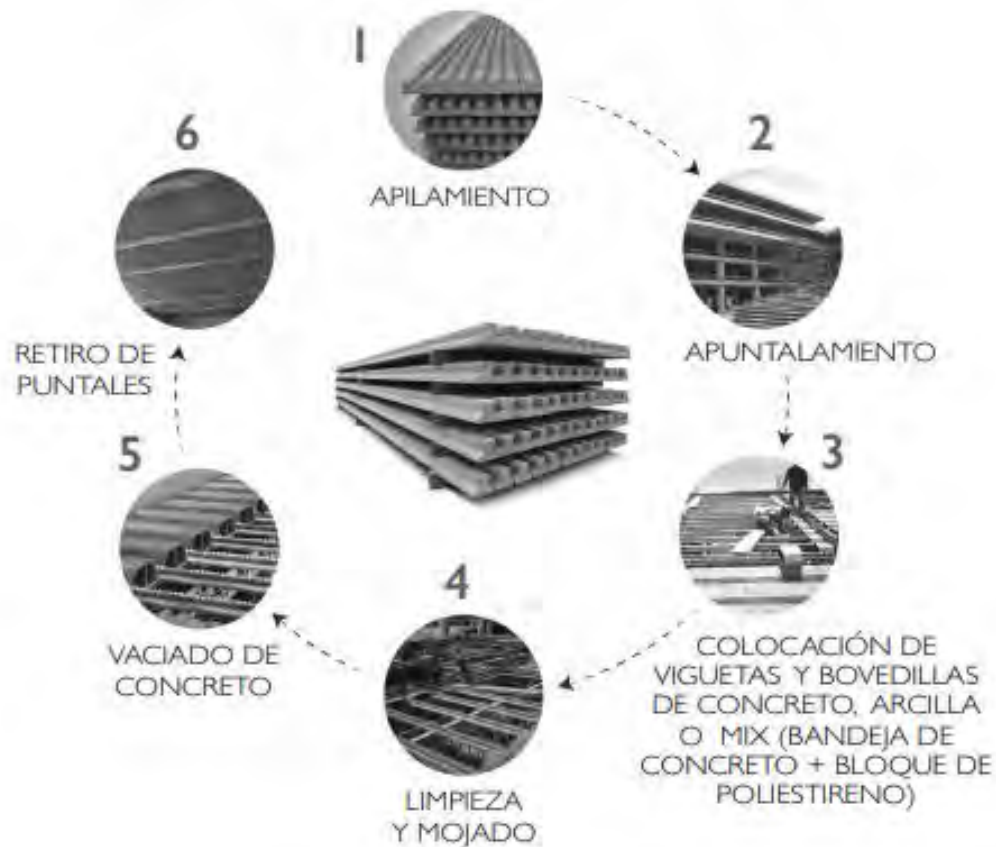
Proceso constructivo con viguetas prefabricadas (Concremax, 2019)
